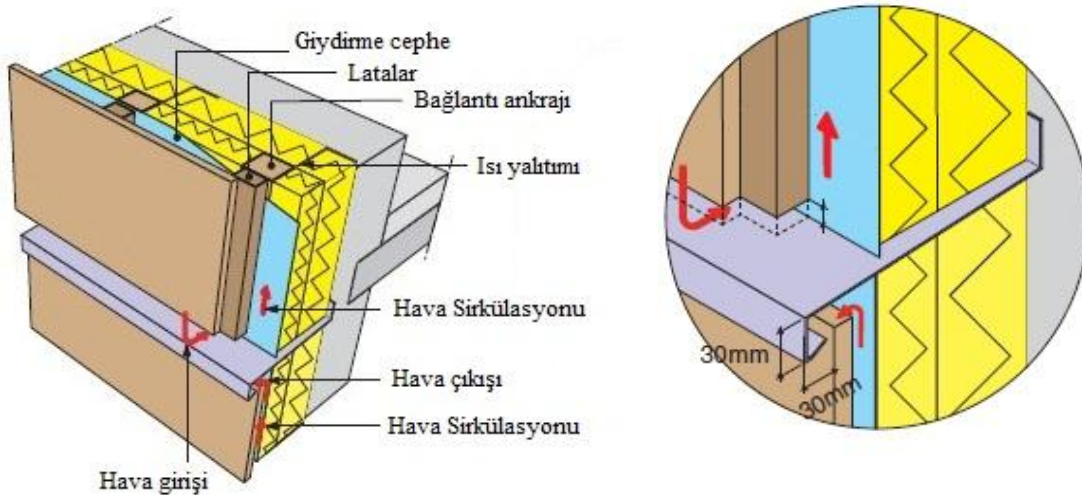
Cephe ve döşeme birleşimlerinde mastik elemanların kullanılması [145]
